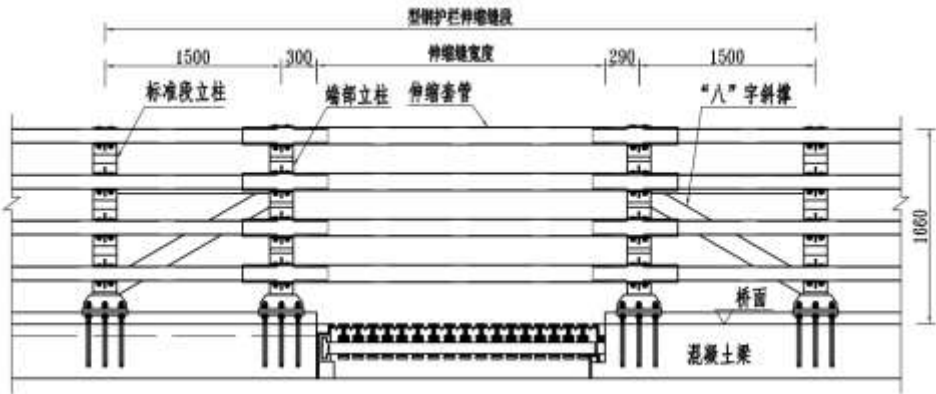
伸缩缝处护栏结构示意图（尺寸单位：mm）
